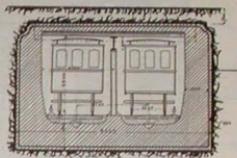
Ferrovia elevata e sotterranea di Berlino sezione trasversale del tunnel.
